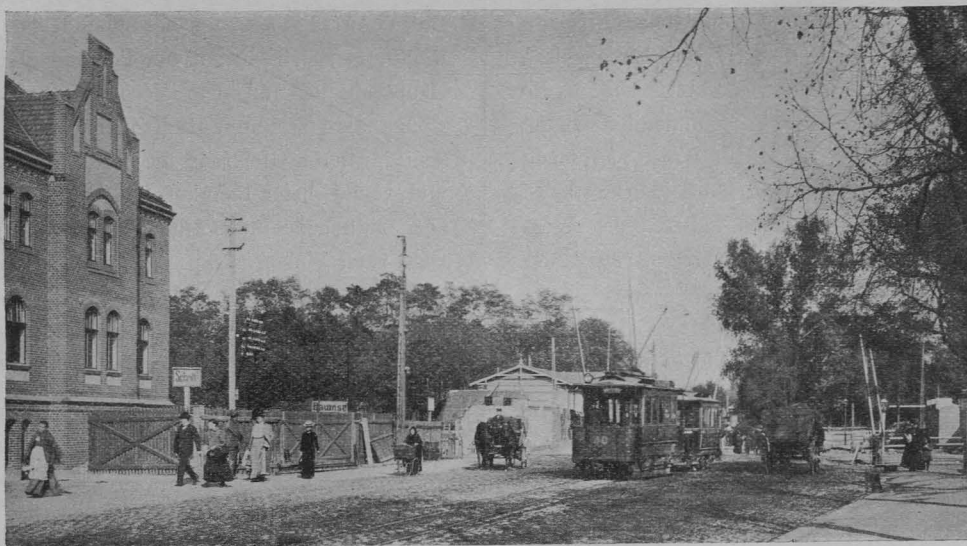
Eisenbahnübergang an der Klosterstraße vor dem Umbau.
